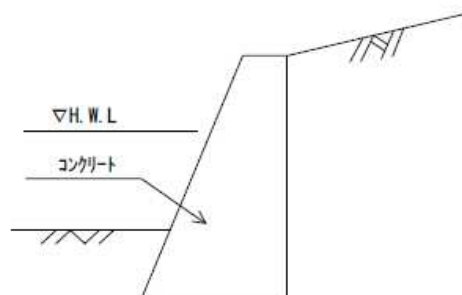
自立式護岸の例(コンクリート擁壁工)
